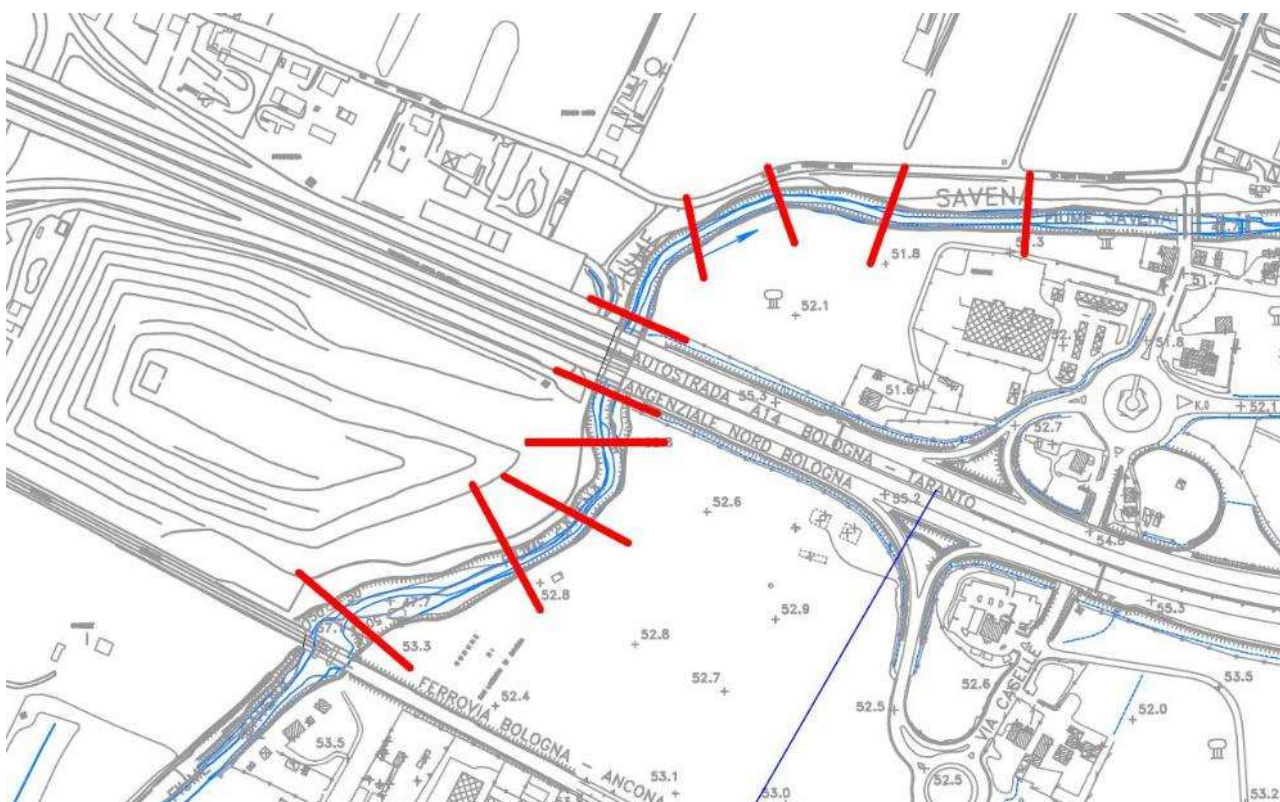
Planimetria sezioni HEC-RAS, torrente Savena
